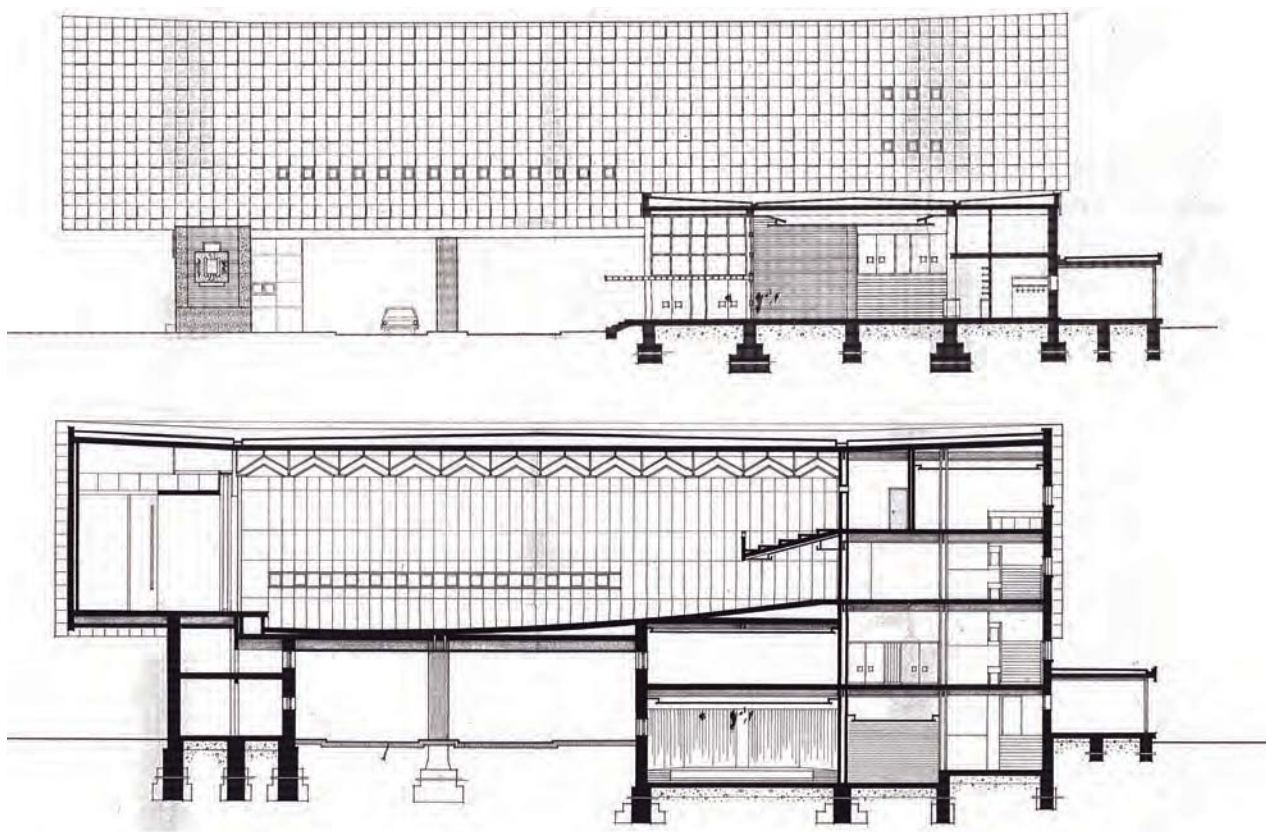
Alzado lateral y sección del edificio de rectoría. Fotografía: Ambrós Escanellas, Manuel, 1966, plano del Proyecto de Ejecución.
